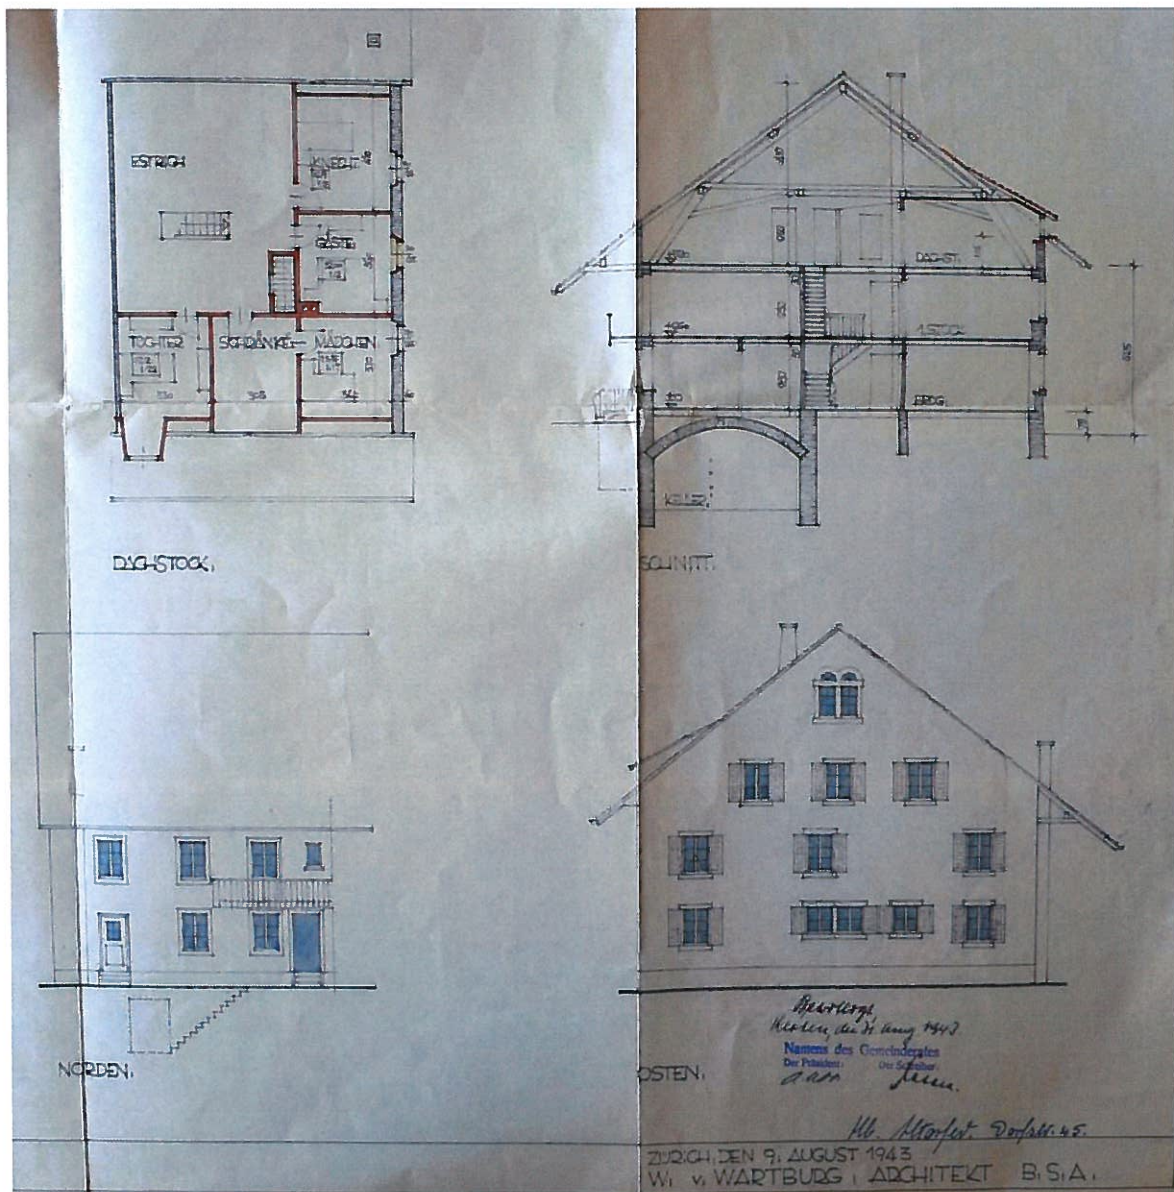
Umbau des Wohnhauses. Nord- und Ostfassade, 1. Dachgeschoss und Schnitt, 9.8.1943. Bauakten Gemeinde Kloten.
